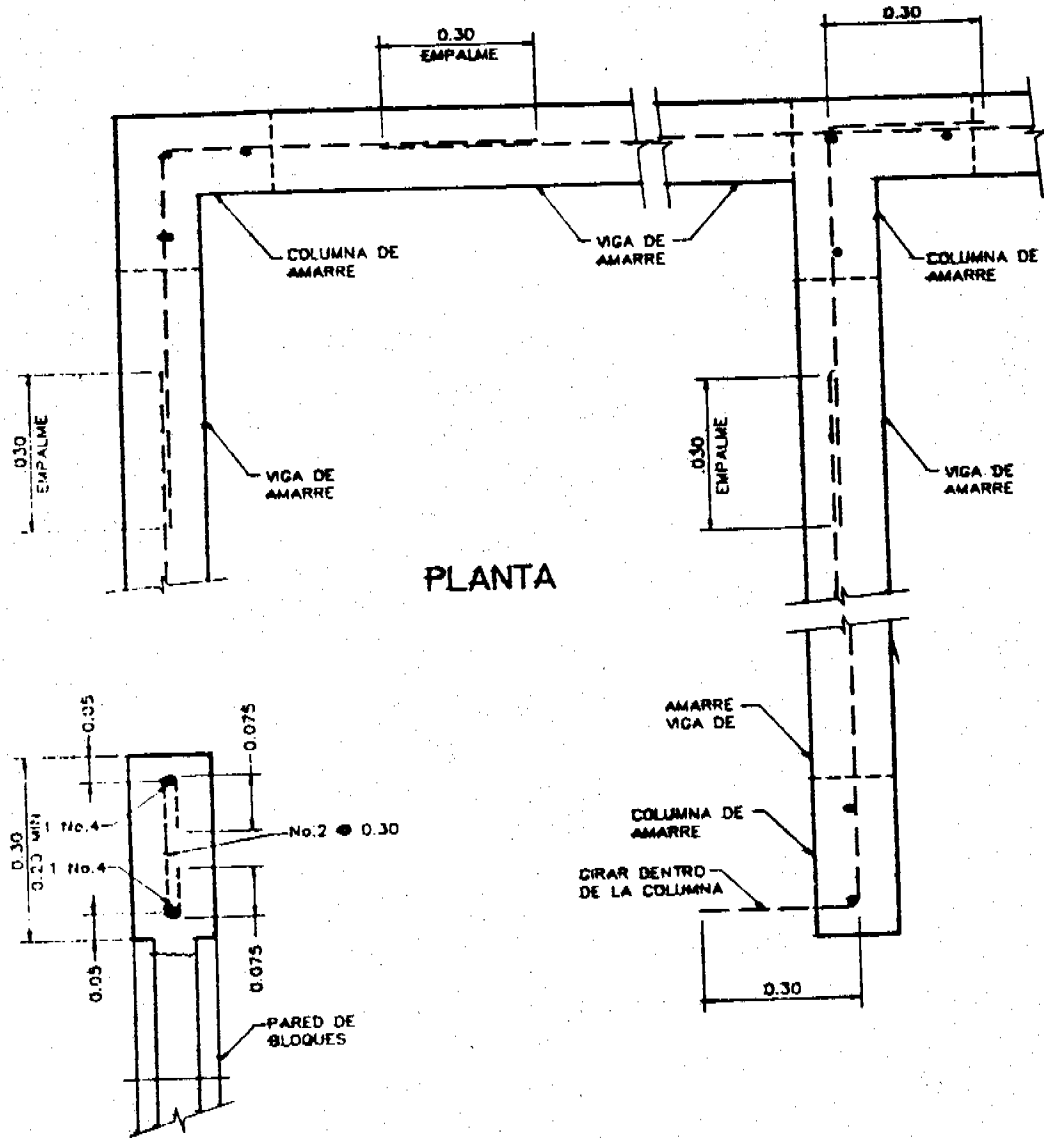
DETALLES TIPICOS DE COLUMNAS DE AMARRE
